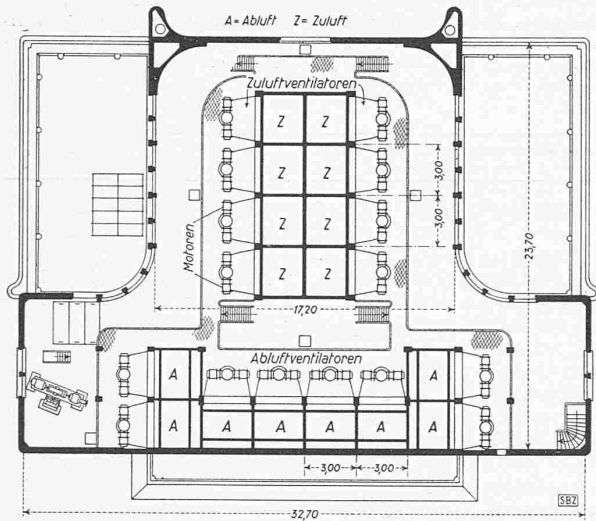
Maschinensaal-Grundriss 1 : 400
